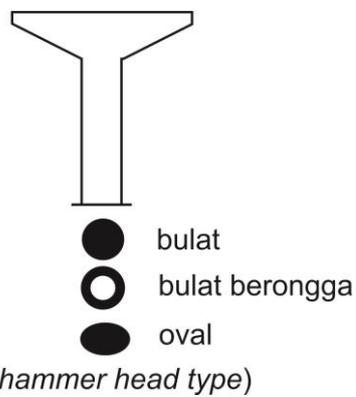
Bentuk pilar jembatan tipe *solid
